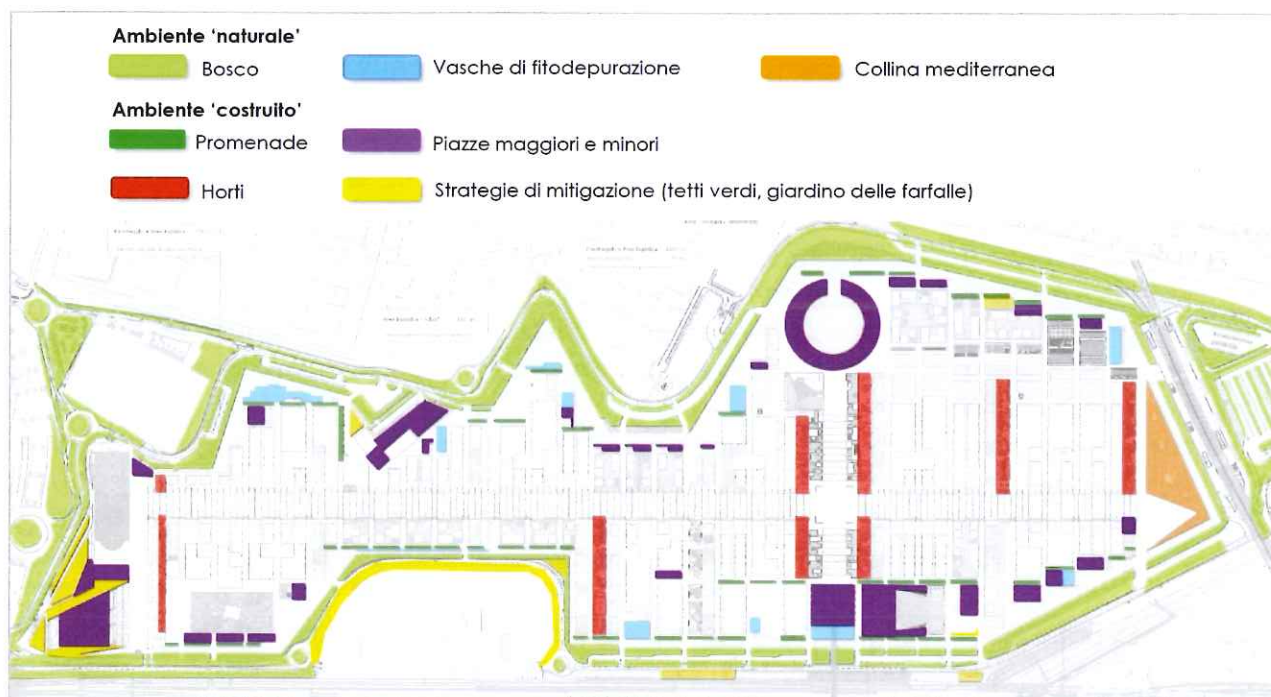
Planimetria indicante la suddivisione delle aree di ambiente "naturale" e "costruito" (Expo 2015)
